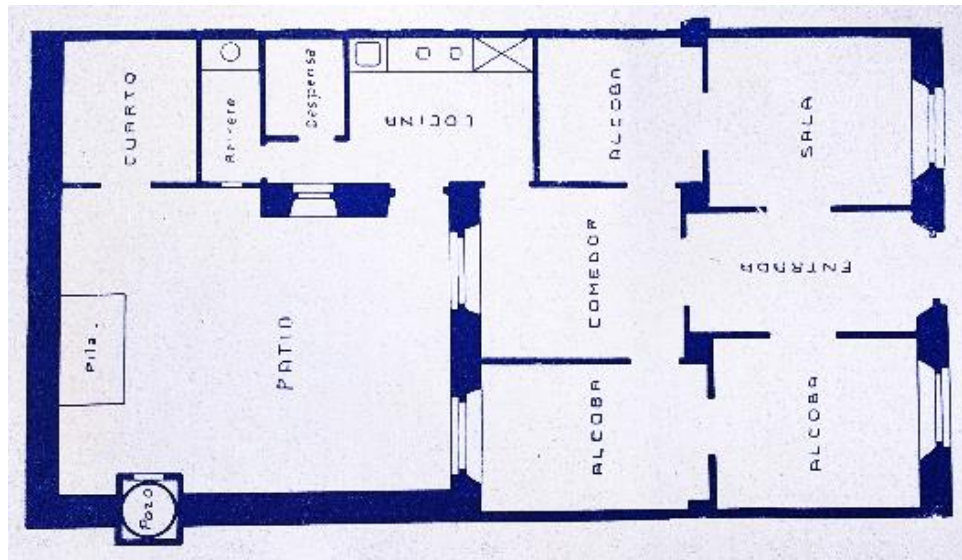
Plano de distribución.1923. La fiesta del taller. [Fuente: Colección privada de Silvente, F.]
